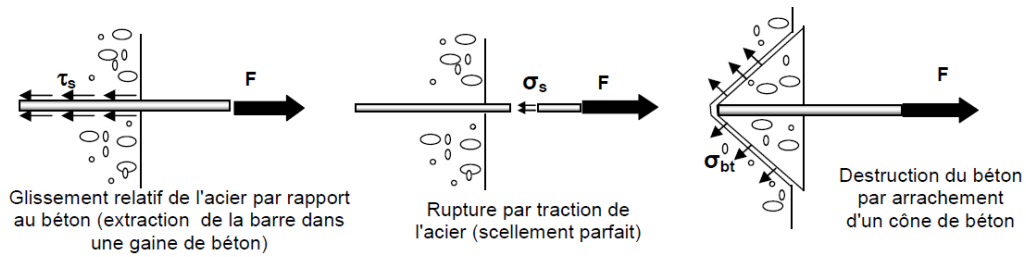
Essai d'arrachement d'une barre scellée dans un massif en béton[10]
